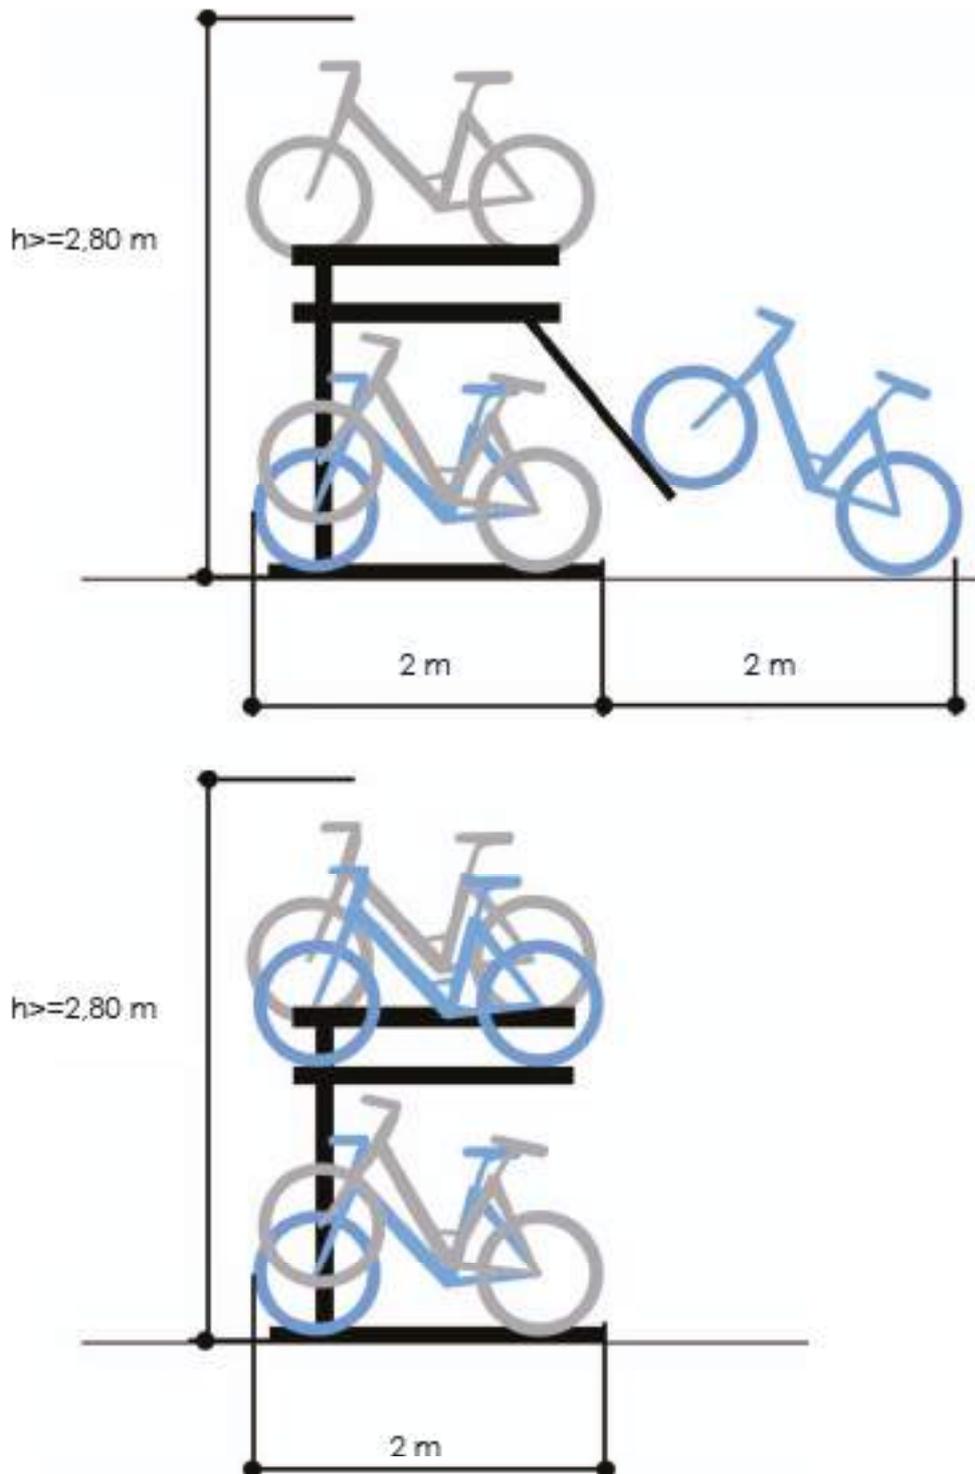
Rangement sur deux niveaux afin à une disposition resserrée
